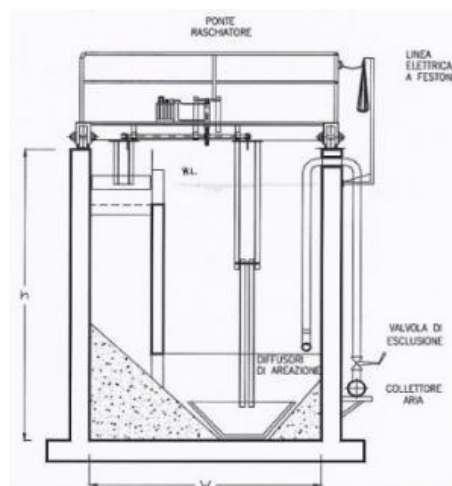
24. Dimensiones y croquis del puente desarenador – desengrasador.
